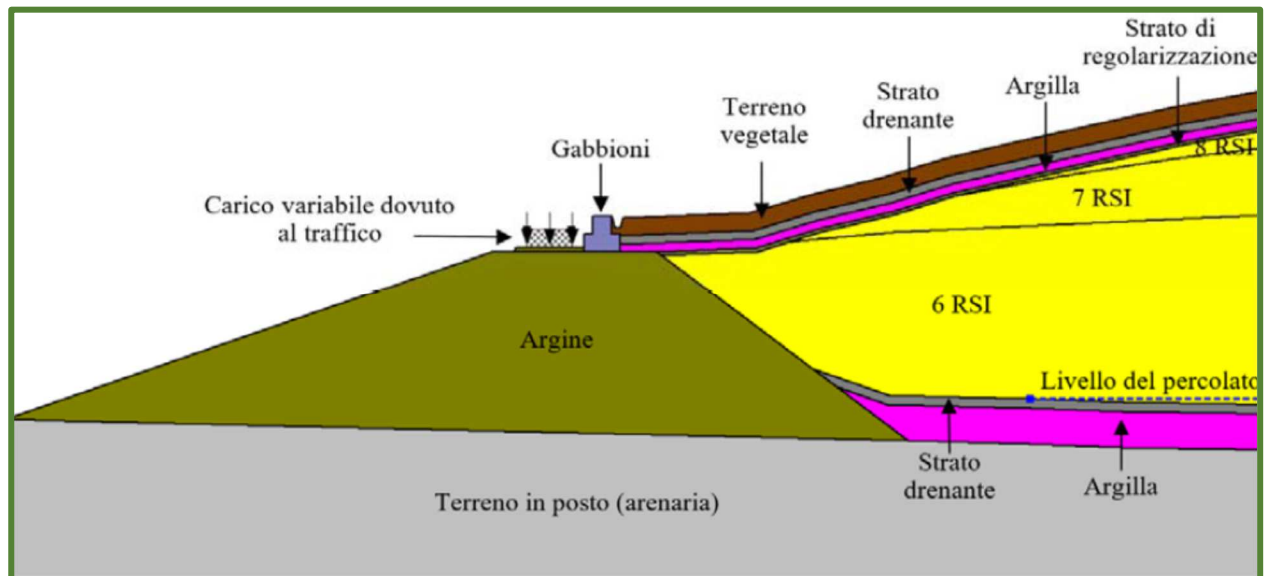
/II – Sezione A-A' – Sponda nord-est - Particolare 1
